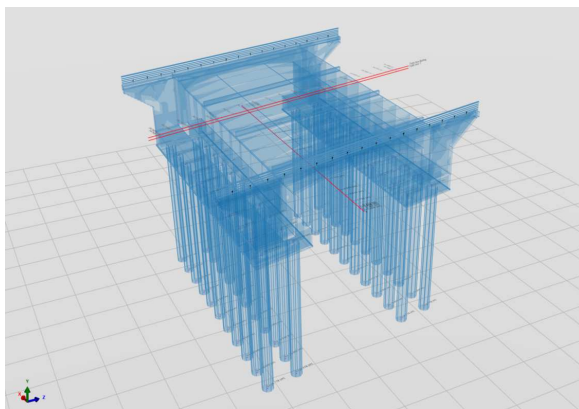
Modelo de paso de fauna generado en Allplan Bridge.
